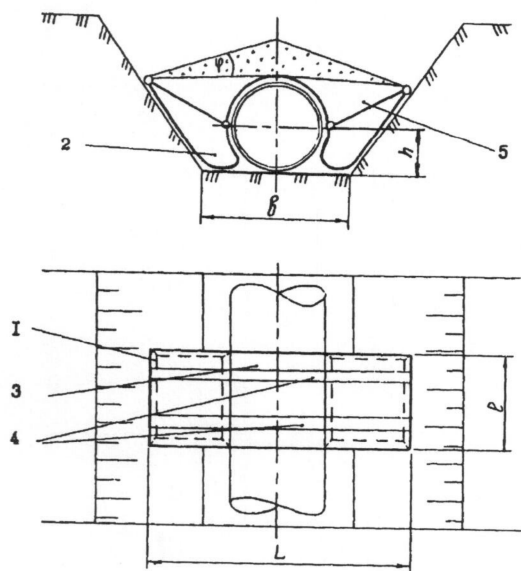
Схема конструкции полимерно-контейнерного балластирующего устройства:
